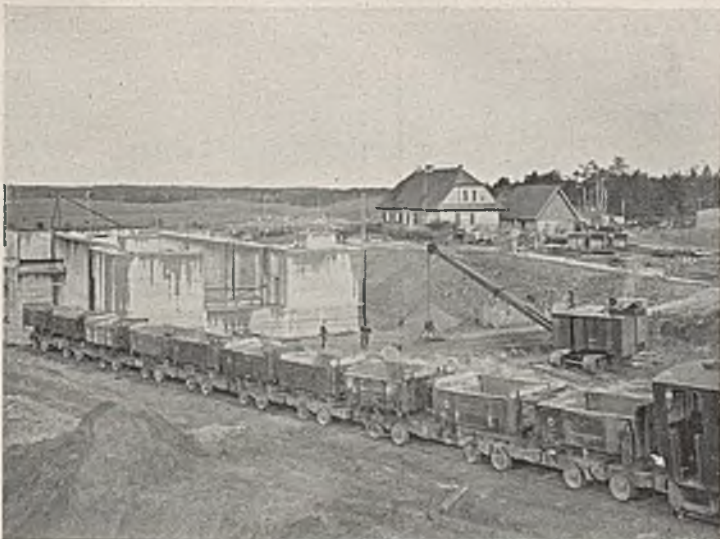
Schachtschleuse Sandhof. Hinterfüllen des Betonbauwerks.
